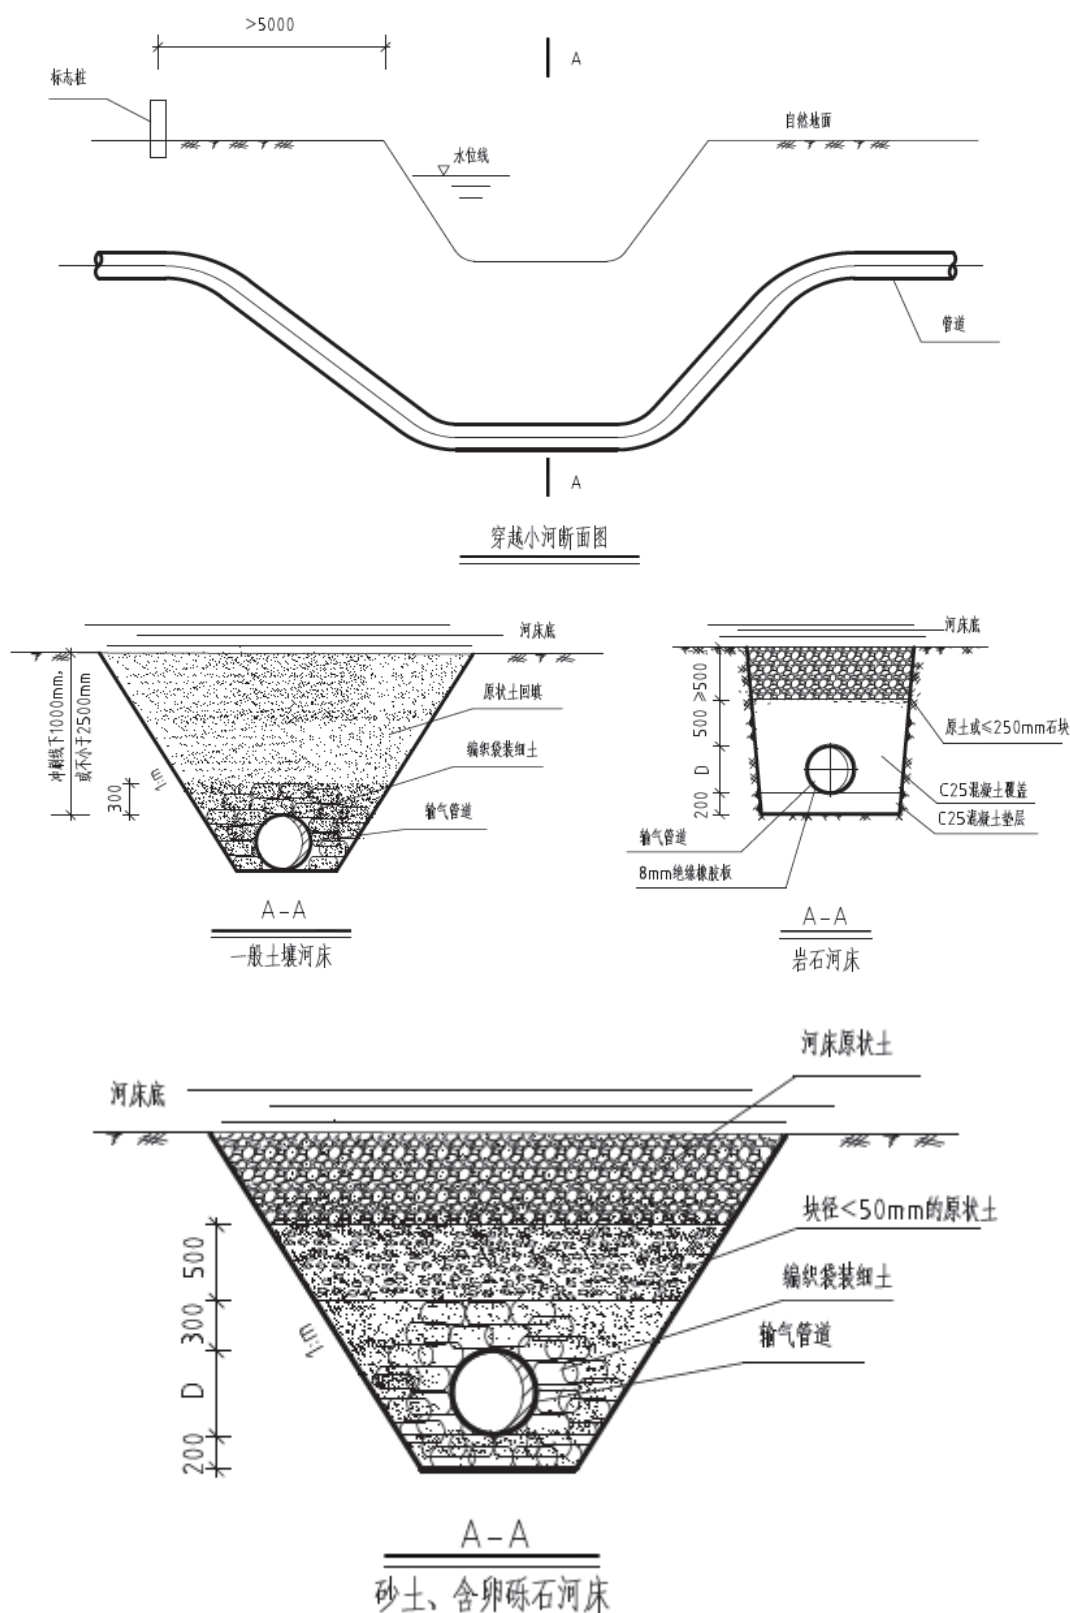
本项目各管道工程穿越沙溪河断面图及剖面图
